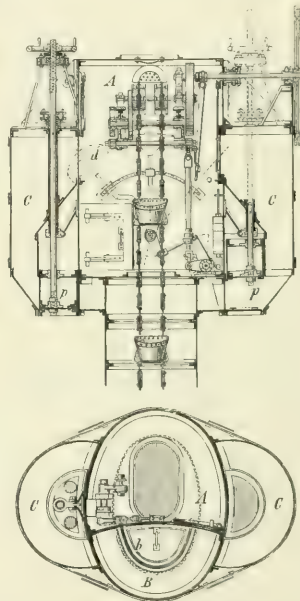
Querschnitt und Grundriß einer Luftschleuse.
